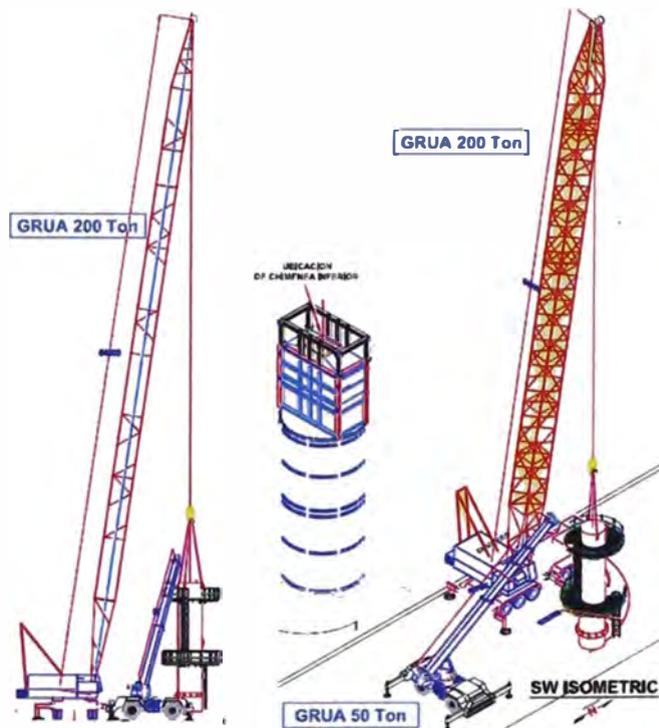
La Chimenea es apoyada sobre tacos de madera para instalar las plataformas de las elevaciones 30,800 mm y 36,800 mm.
